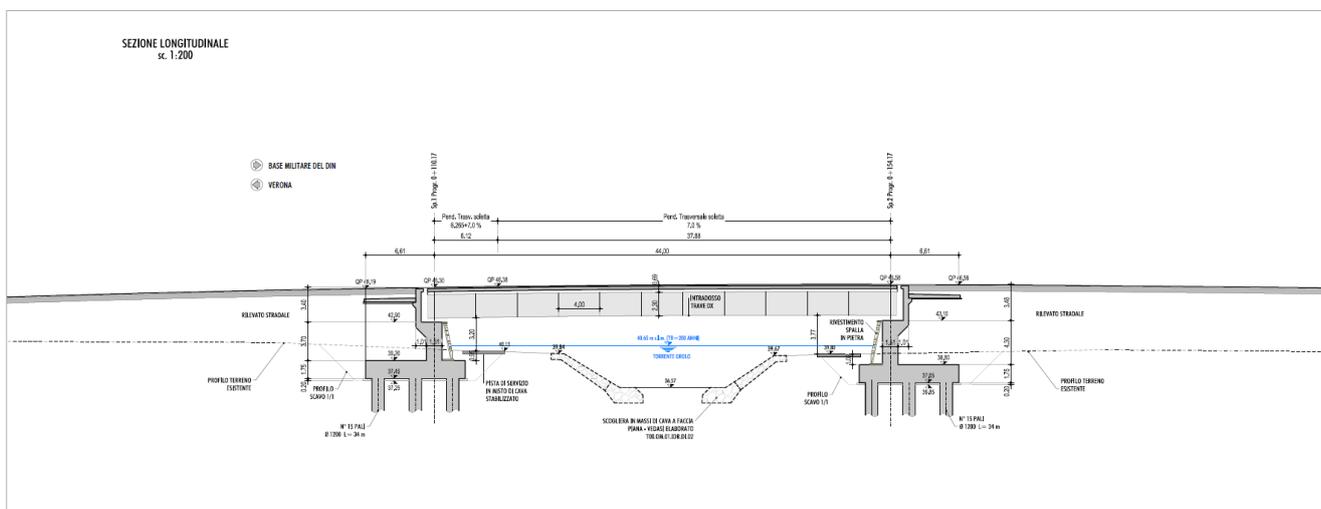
SEZIONE LONGITUDINALE DEL PONTE
